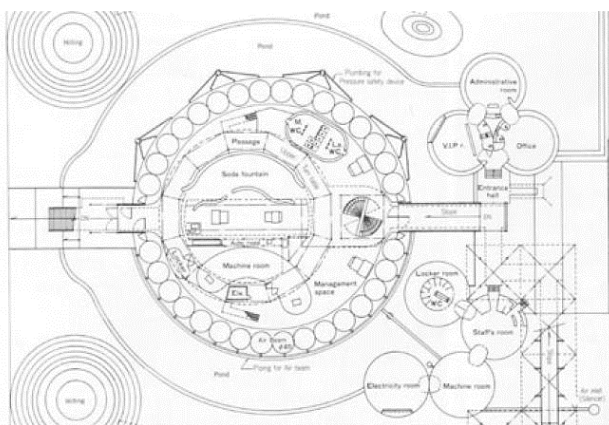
Plan rez de chaussé du pavillon Fuji
